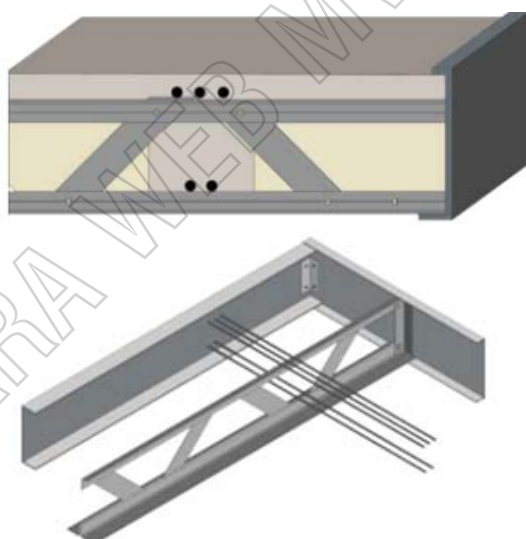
Esquemas de detalles constructivos en caso de utilizar chapa plegada en techos con voladizo. Arriba: Corte transversal del techo. Abajo: representación de los elementos metálicos del techo.
